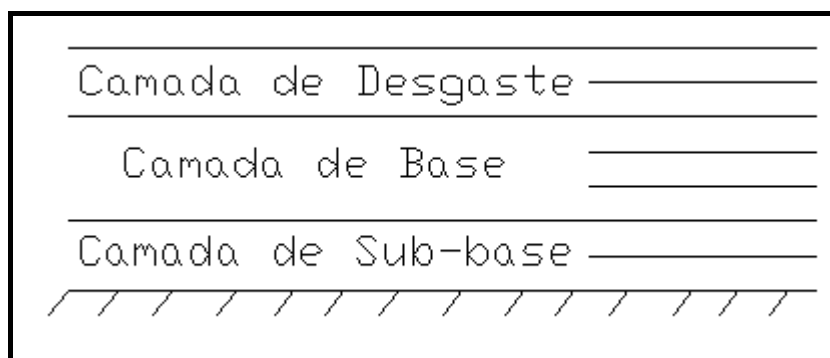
Esquema estrutural de um Pavimento Flexível corrente
